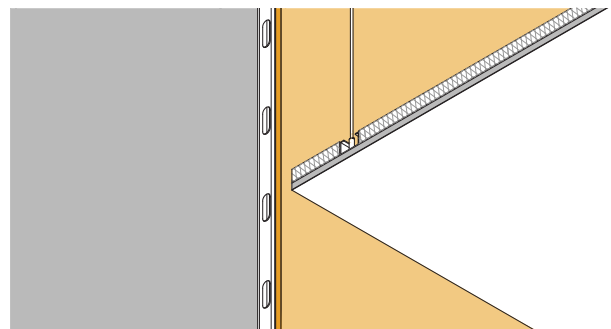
Pormenor de teto suspenso aplicado posteriormente
